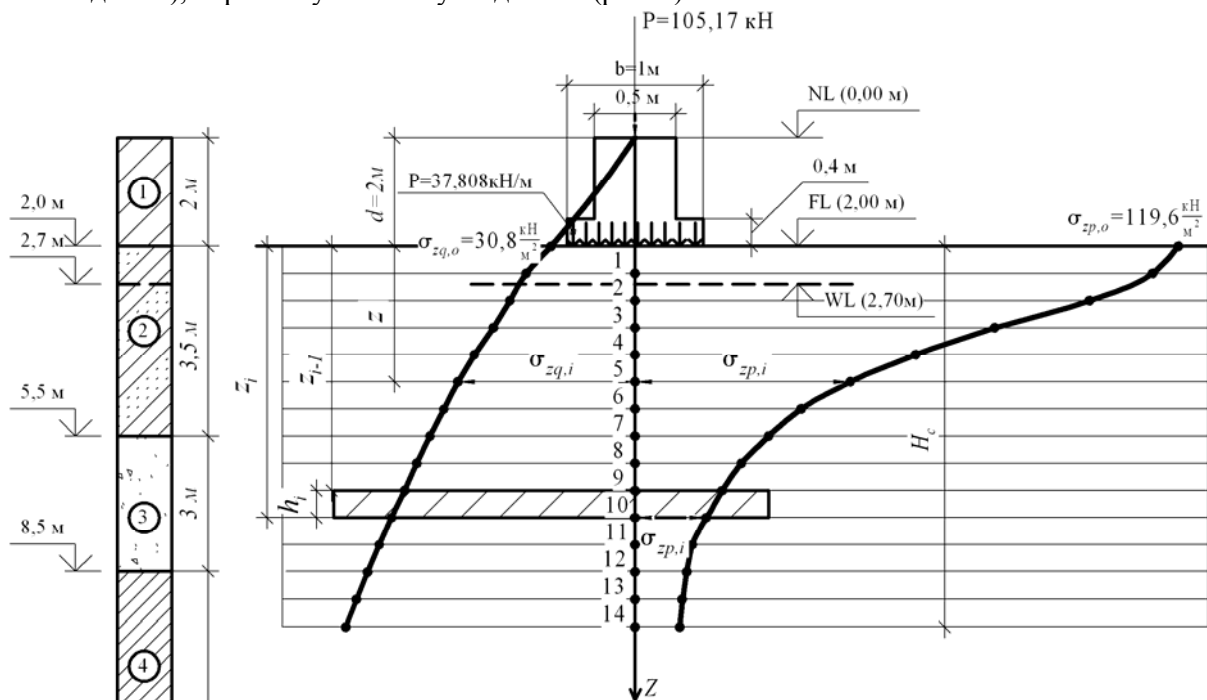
Розрахунок осідання фундаменту за методом пошарового підсумовування для визначення коефіцієнта жорсткості основи. 1 – насипний ґрунт; 2 – супісь; 3 – пісок пилуватий; 4 – глина; b – ширина фундаменту; d – глибина закладання фундаменту (FL) від поверхні природного рельєфу (NL); $\sigma_{zq,o}$, $\sigma_{zq,i}$ – вертикальні напруження від власної ваги ґрунту під підшвою фундаменту на глибині z від підшви фундаменту (природний тиск ґрунту); $\sigma_{zp,o}$, $\sigma_{zp,i}$ – додатковий вертикальний тиск від зовнішнього навантаження; H_c – товщина стиснутої зони ґрунту основи (активна зона)
